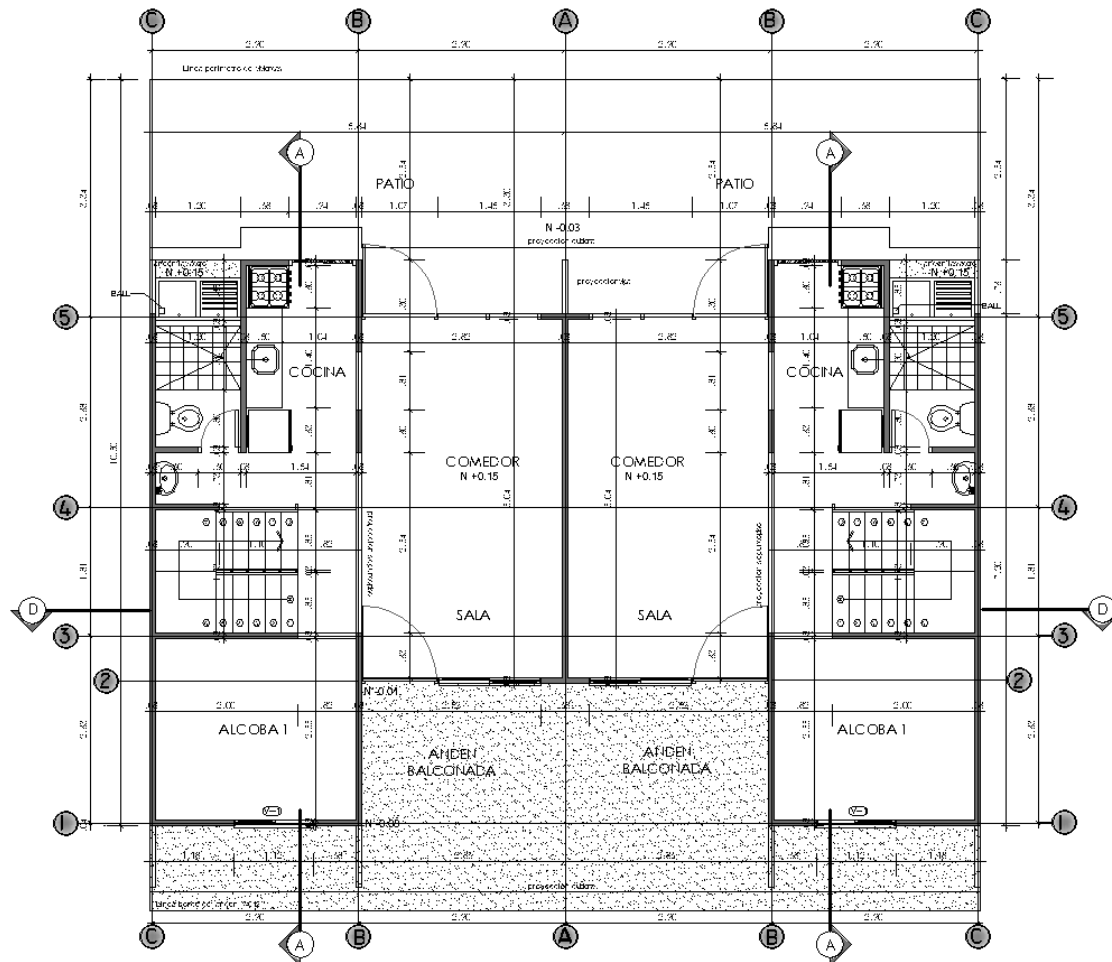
planta arquitectónica piso 1 (muros prefabricados-SC), macro-proyecto San Antonio. Fuente: Arq. Jemay Parra Ocampo.
